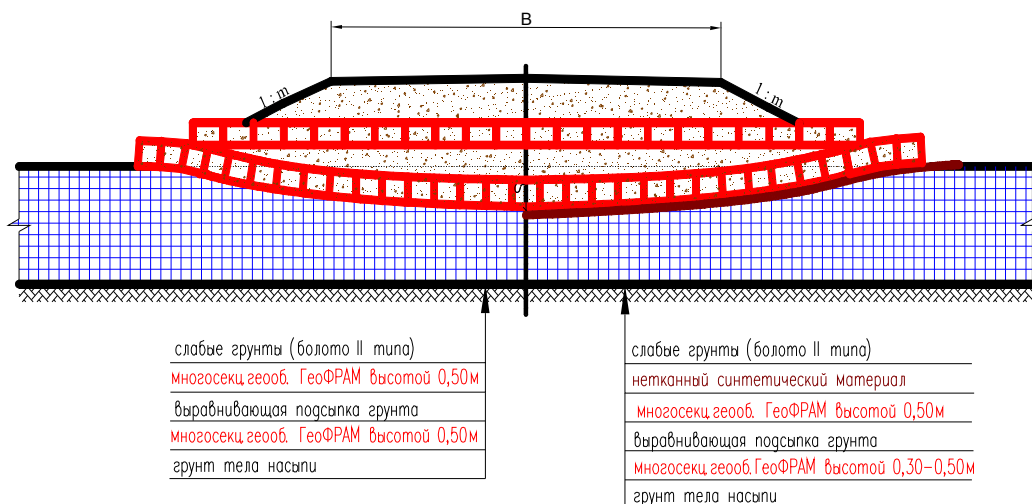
Конструкция насыпи высотой более 2-х метров на слабых основаниях I-го типа сооружаемая в два этапа.
